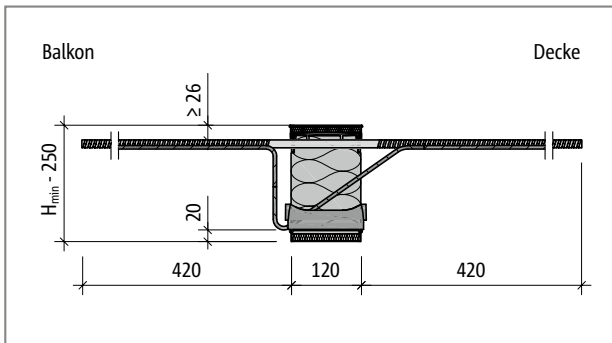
Schöck Isokorb® CXT Typ K-M6-V1: Produktschnitt
